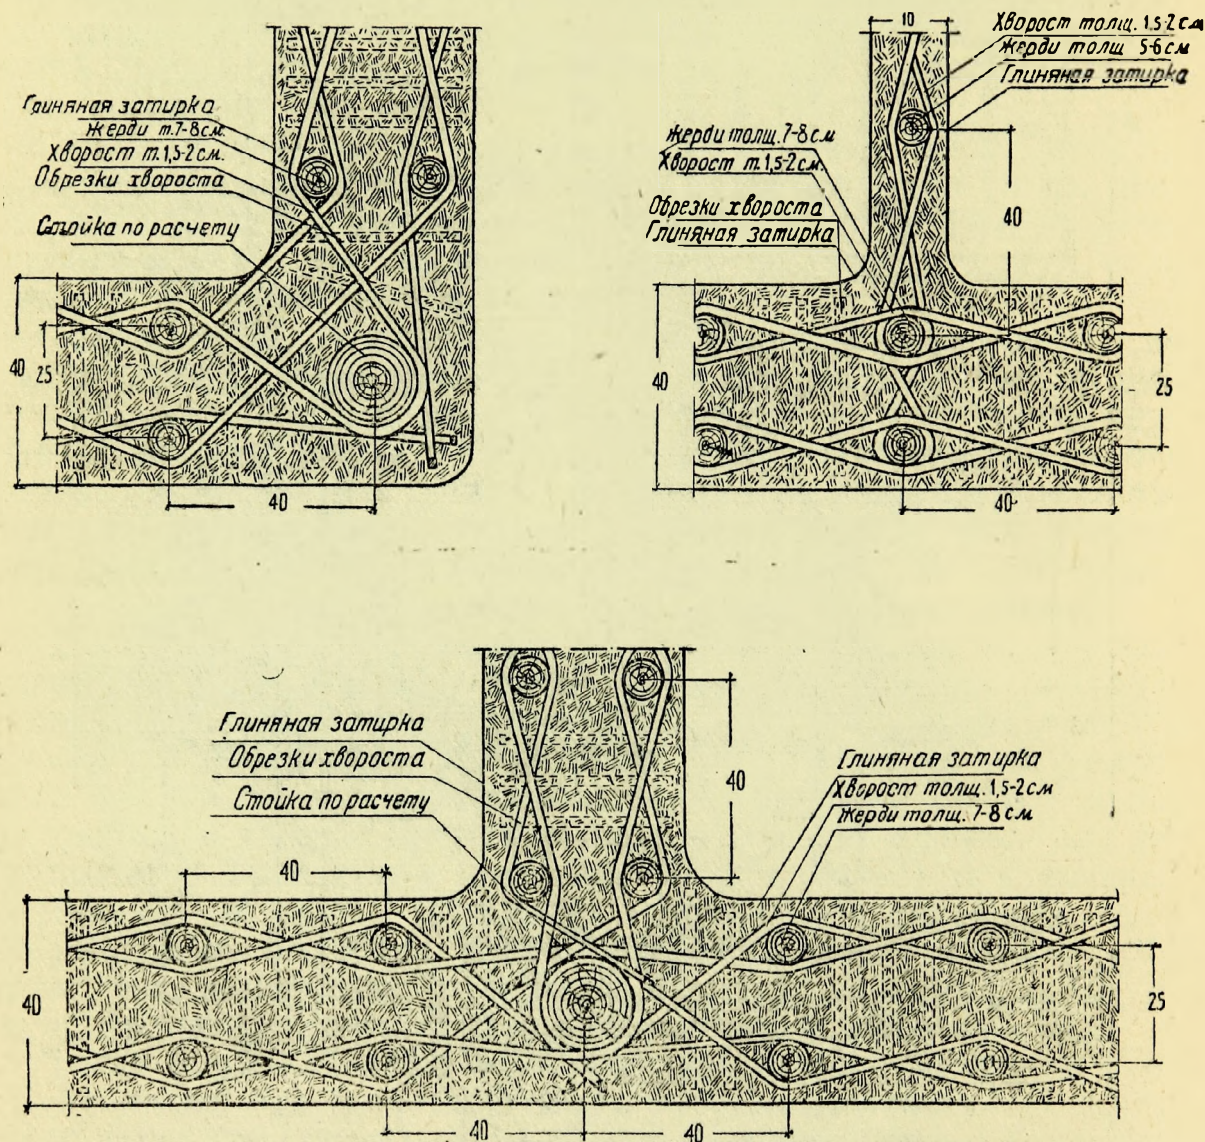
Соединения глиноплетневых стен в местах пересечений.
